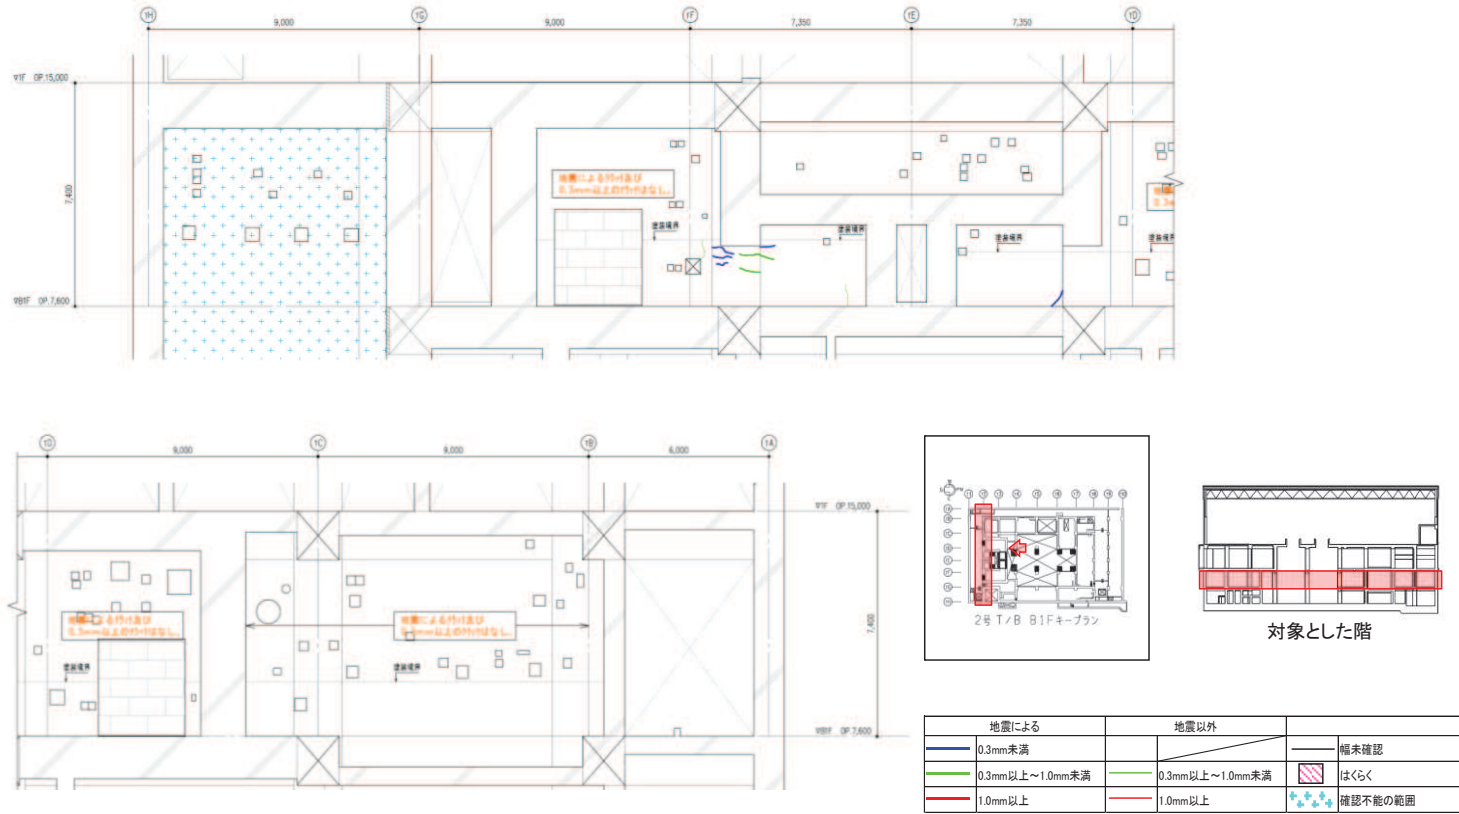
タービン建屋のひび割れ分布 耐震壁 (18) 地下 1 階 T2 通り
